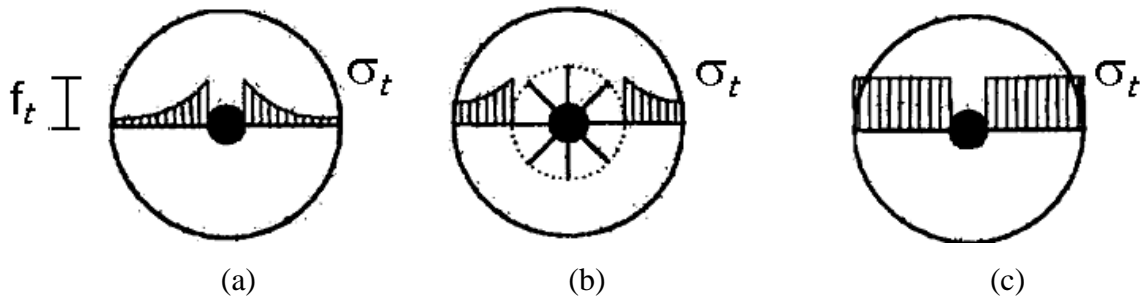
Modelos para a predição da fissuração longitudinal: (a) Elástico, (b) Elástico parcialmente fissurado e (c) Plástico [Tepfers, 1983].
